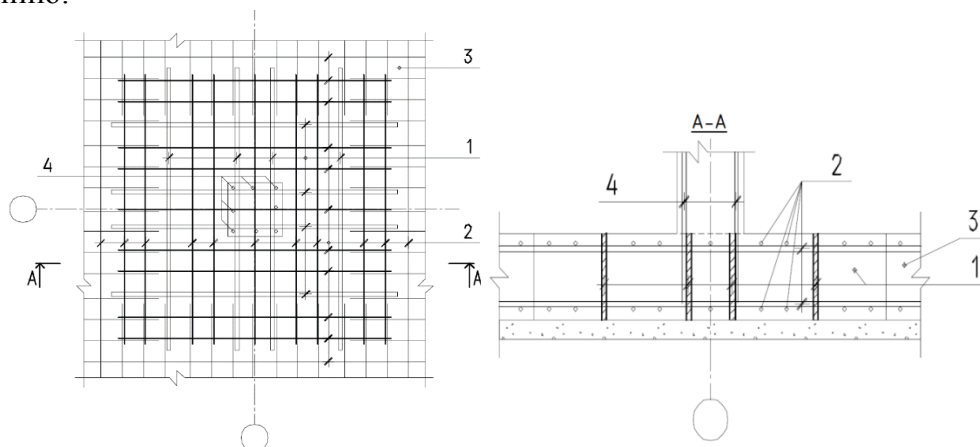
Конструктивное решение безбалочного перекрытия с использованием металлических пластин: 1 – металлические пластины, 2 – ненапрягаемая и/или напрягаемая арматура, 3 – бетон, 4 – продольная арматура колонн
